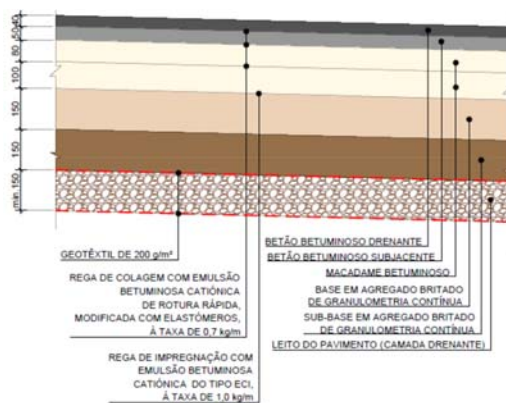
Estrutura do pavimento entre o km 8+834.35 e o km 9+201.250
